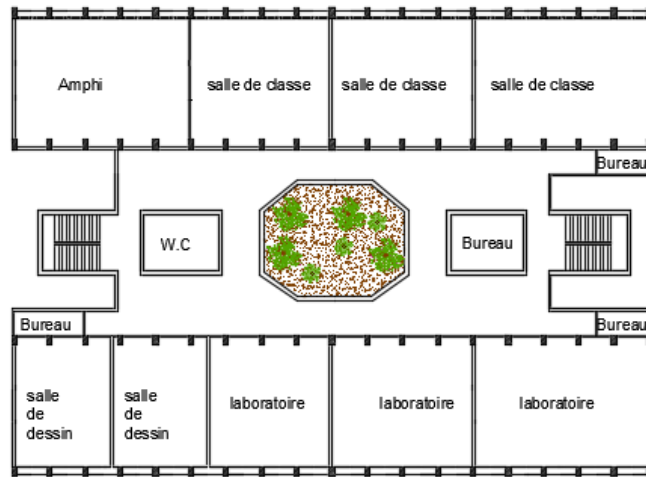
Plan Rez-de-chaussée (Source : Auteur)
